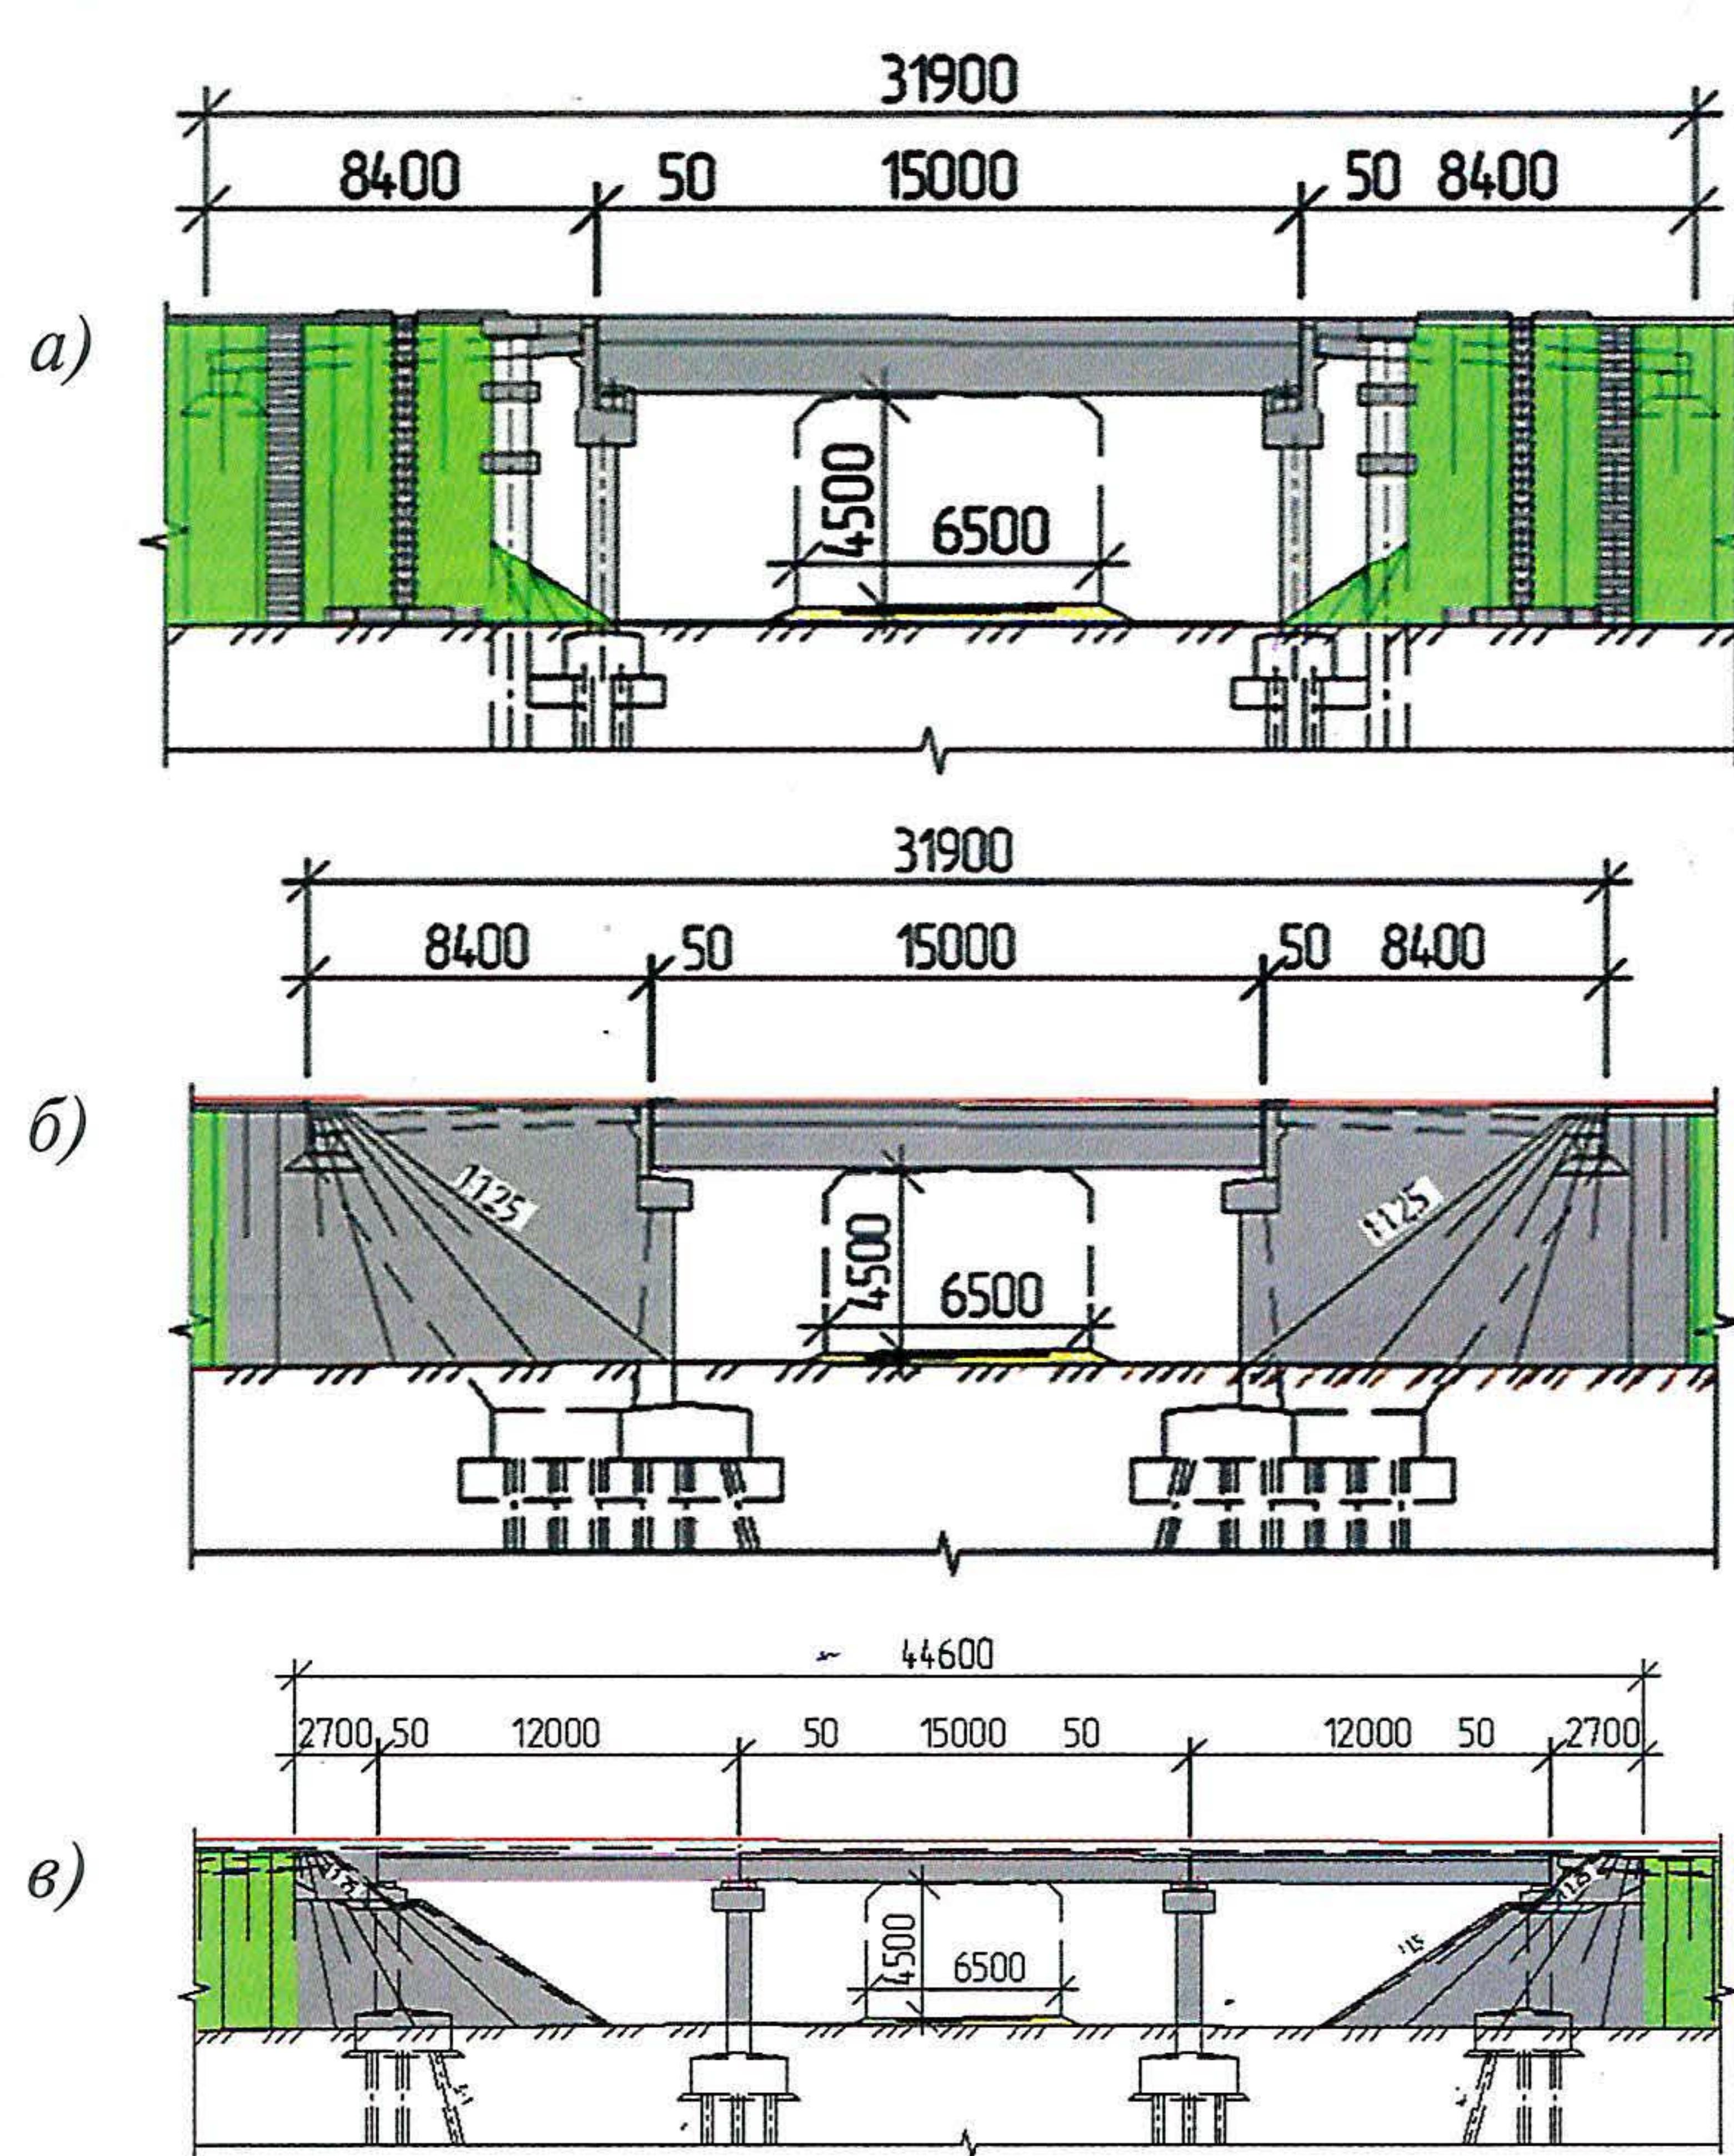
Схемы вариантов путепровода: а – схема 1, путепровод с устоями из ШТС, б – схема 2, однопролетный путепровод с устоями из железобетона, в – схема 3, трехпролетный путепровод с обсыпными устоями
